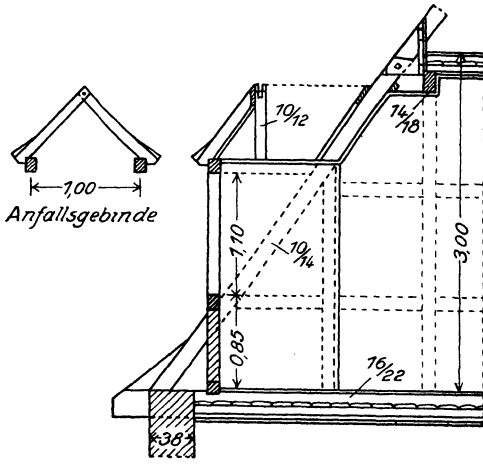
Dachfenster mit abgewalmtem Satteldach.
